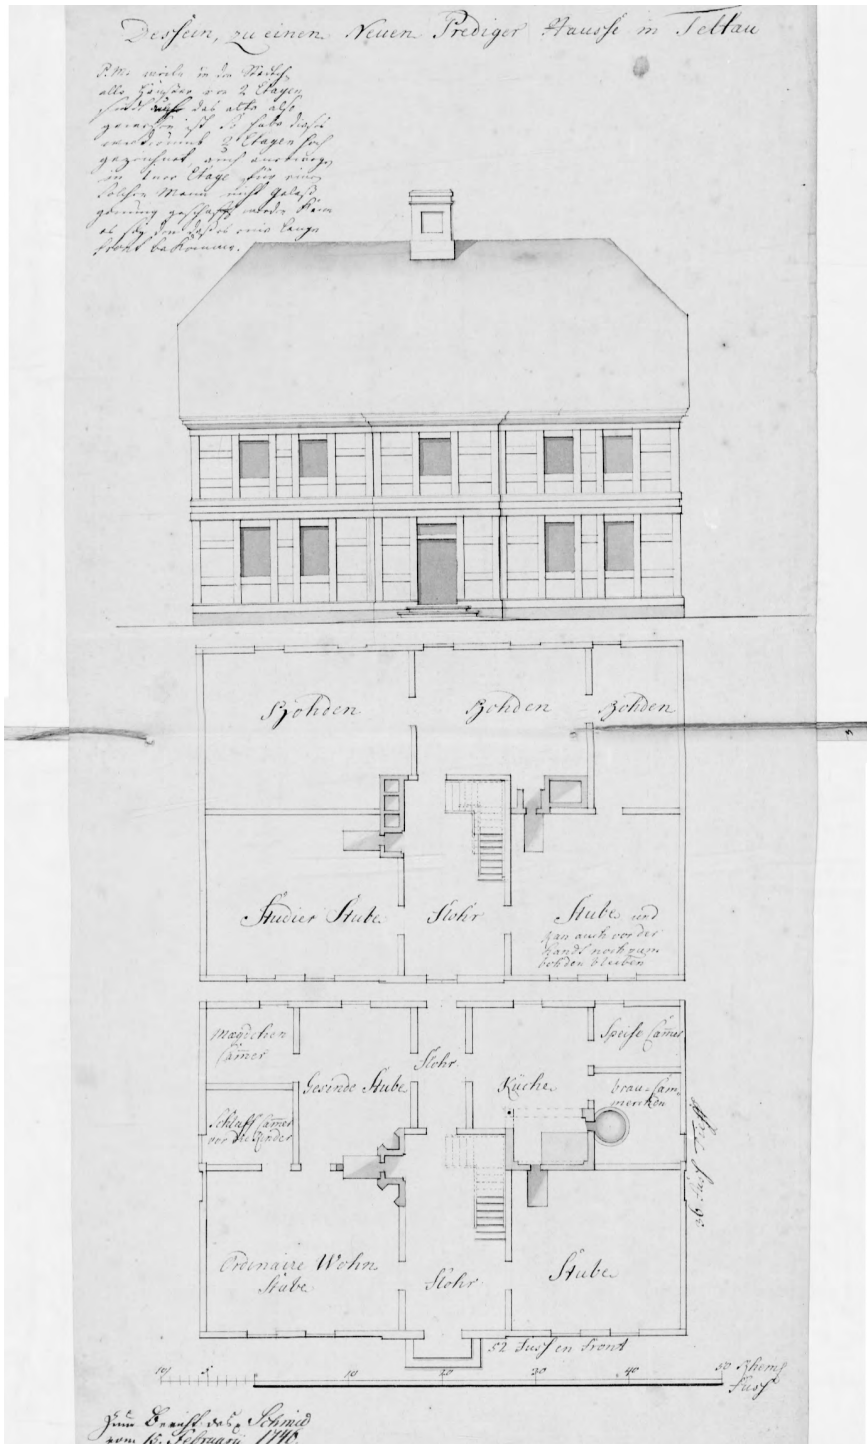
Pfarrhaus. Ansicht und Grundrisse in Fachwerk 1746
